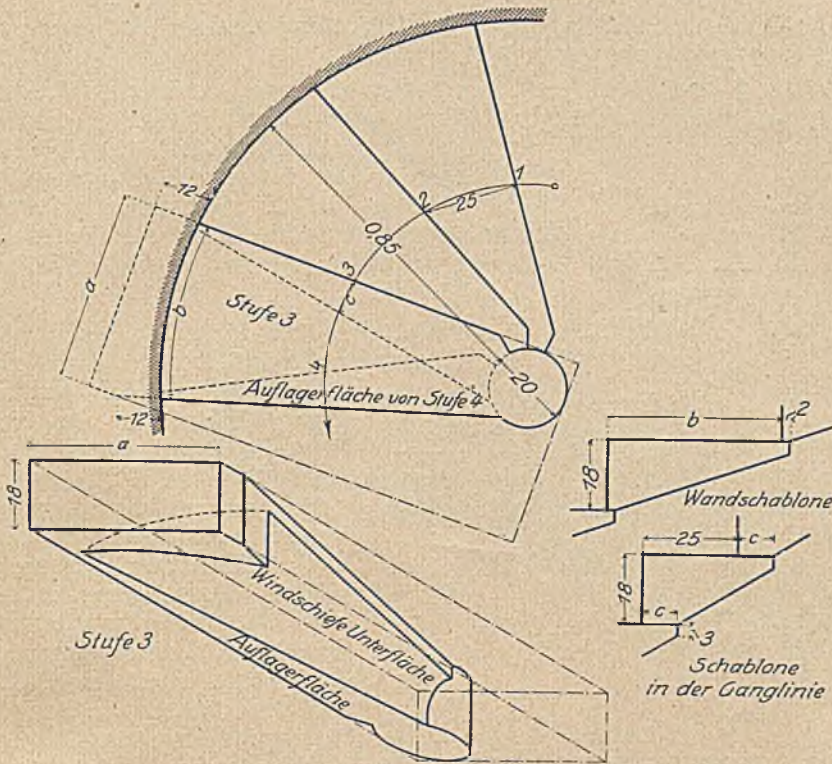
Spindeltreppe mit an die Stufen gearbeiteter Spindel.
